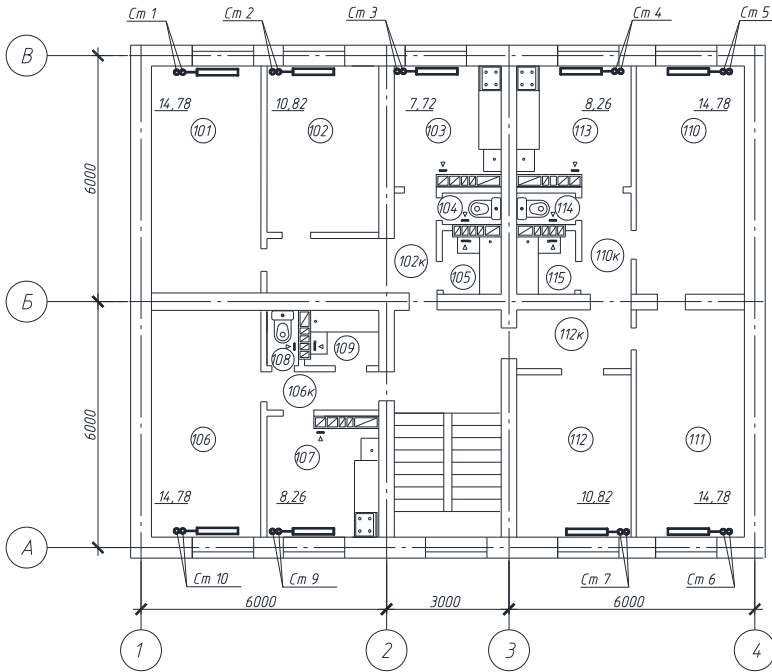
План типового этажа с нижней разводкой трубопроводов и приставными шлакобетонными вентиляционными каналами
